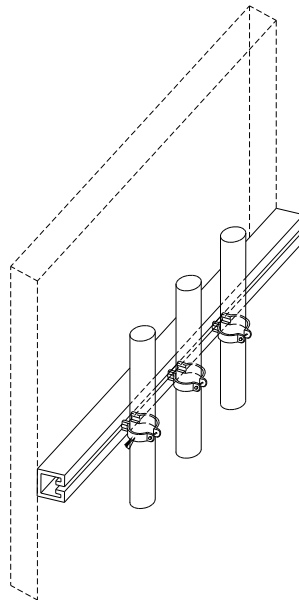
Detalle de sujeción de una tubería conduit en un muro, mediante un canal de acero y abrazaderas.
